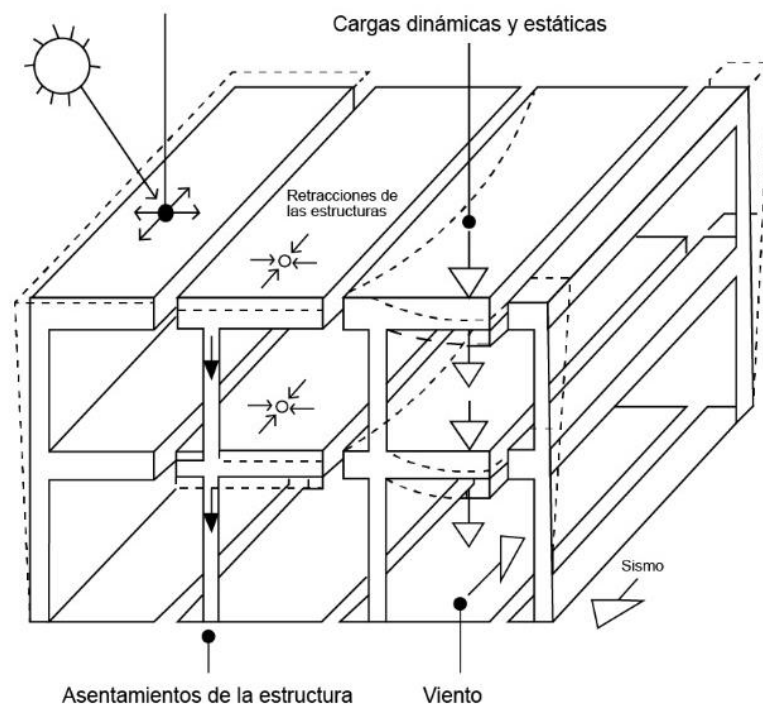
Grietas por dilataciones y contracciones térmicas
